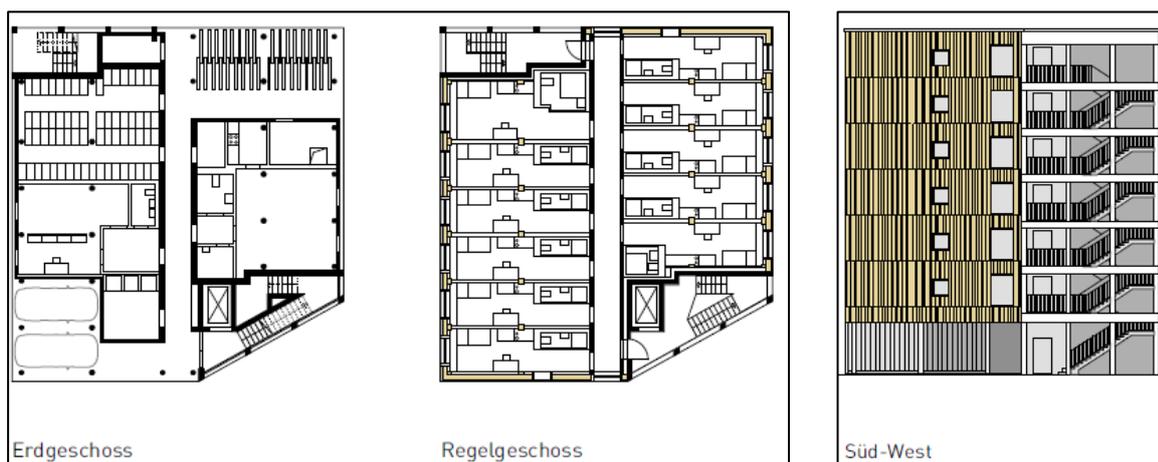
Grundriss, Atelier PK Architekten
